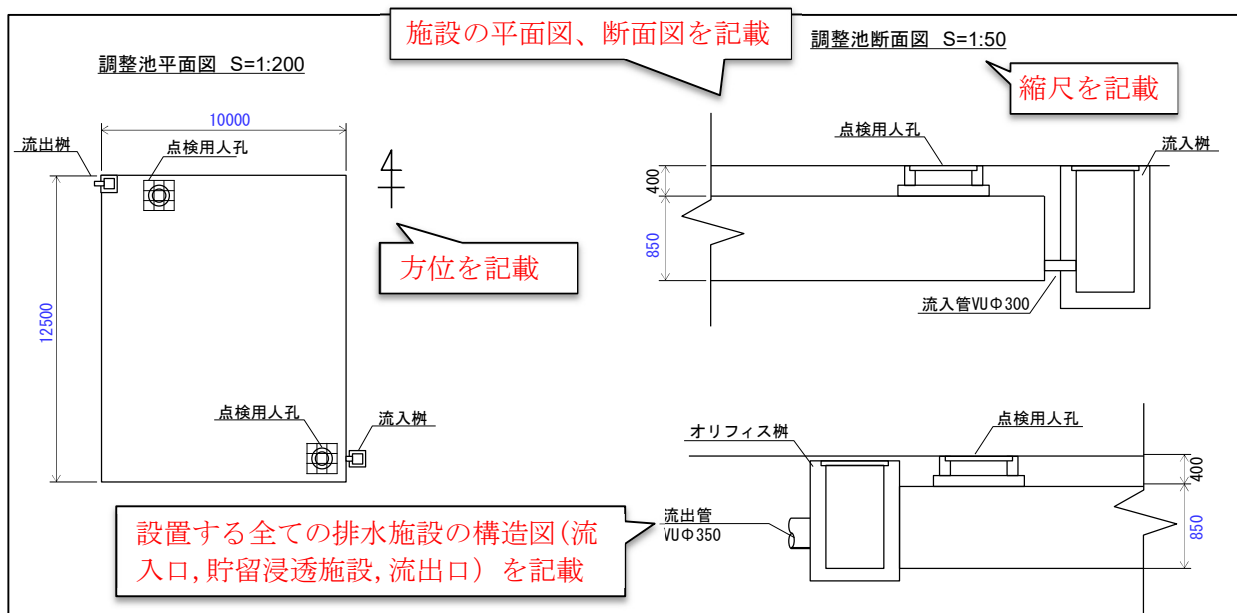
対策工事に係わる雨水貯留浸透施設の計画図(図面-9)の作成例(調整池平面図、断面図)
